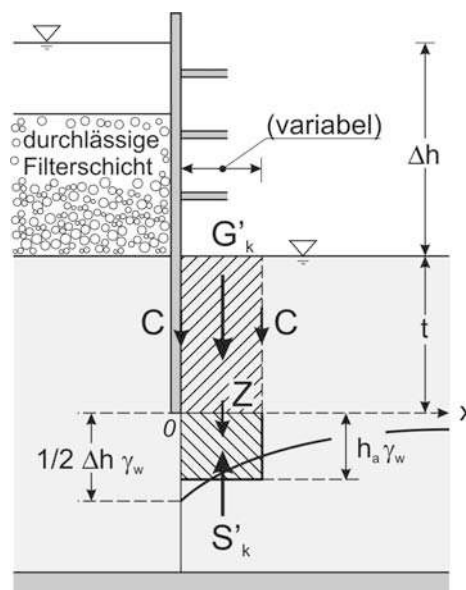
Hydraulischer Grundbruch im bindigen Baugrund (nach DAVIDENKOFF (1970))
